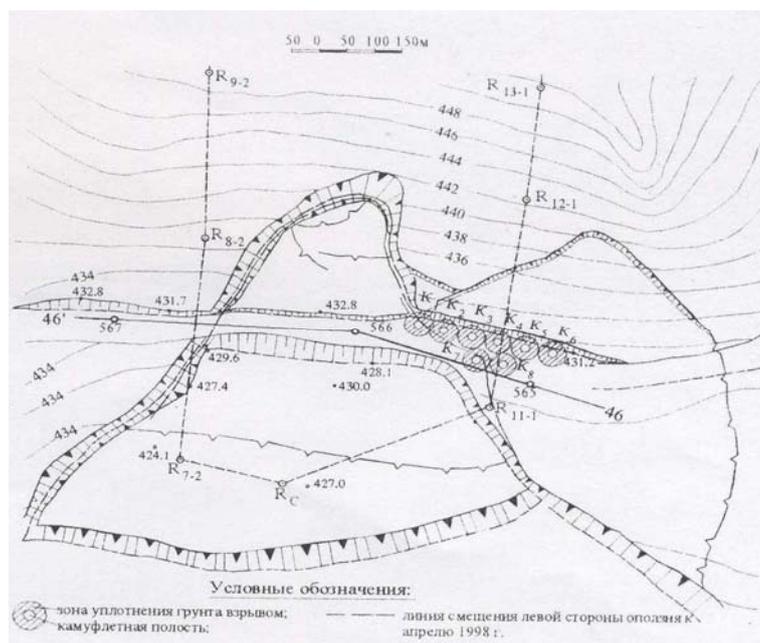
План опытно-экспериментального участка по глубинному закреплению грунтов камуфлетными шпонами
